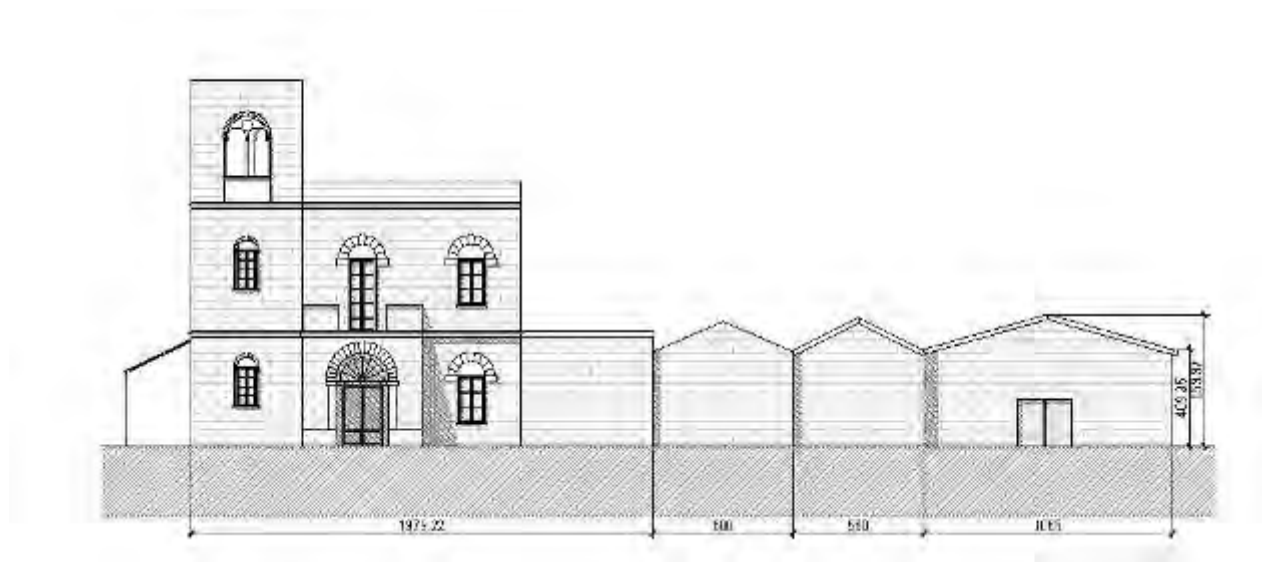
Stato di Fatto - Complesso Curto. Prospetto Nord
